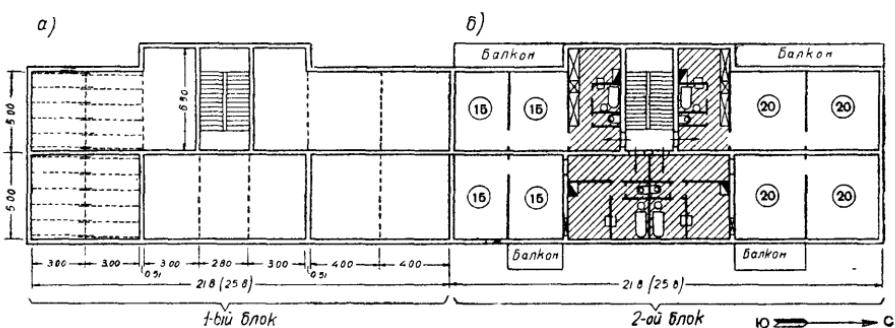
Схема планировки двухкомнатных квартир. Все вспомогательные помещения у входов, вокруг лестницы. Каждая квартира имеет одну проходную комнату для уменьшения вспомогательных помещений. Обязательная меридиональная ориентировка. Жилая площадь квартир по 30–40 м² (а — схема опор и перекрытий; б — схема планировки)
